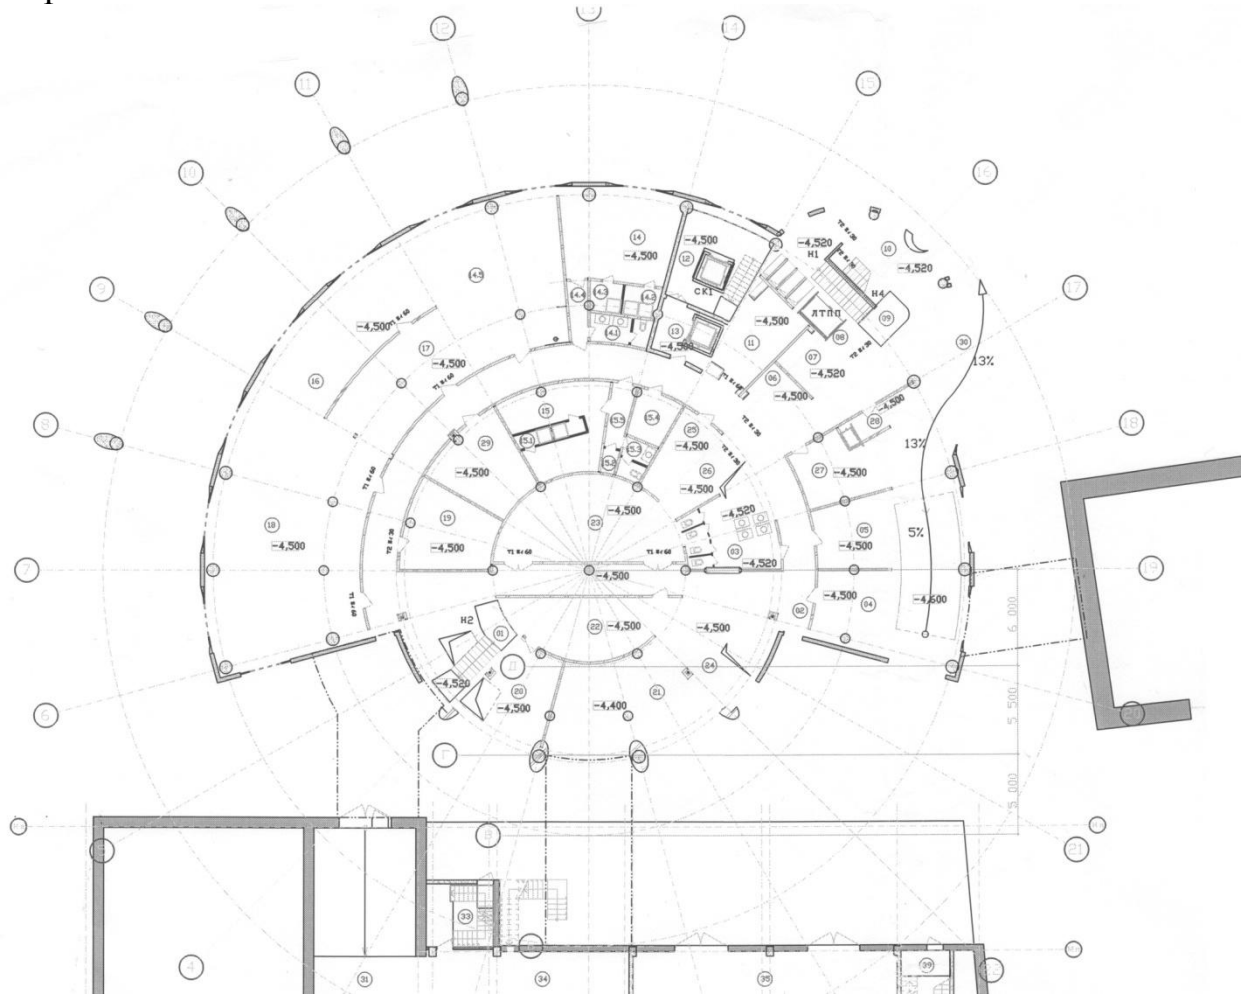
Схема розміщення огорожувальної конструкції «стіна в ґрунті» котловану 17-ти поверхової будівлі.
